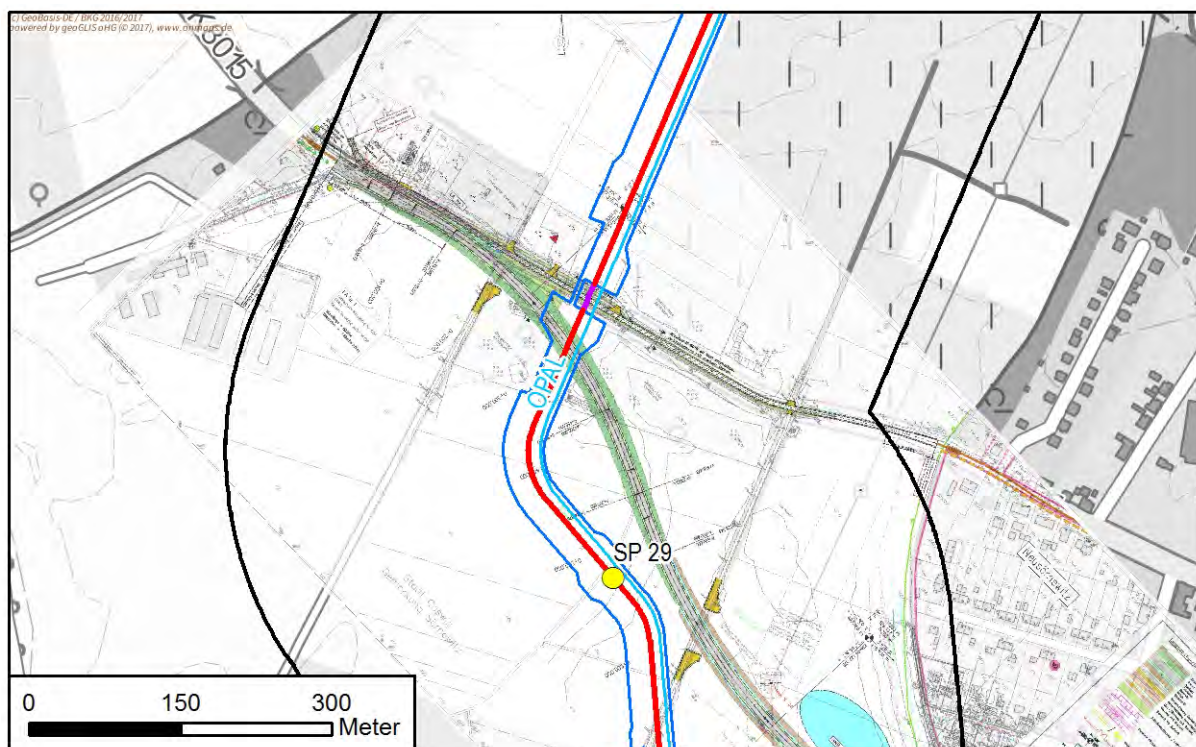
Geplanter Neubau der Staatsstraße S 84
